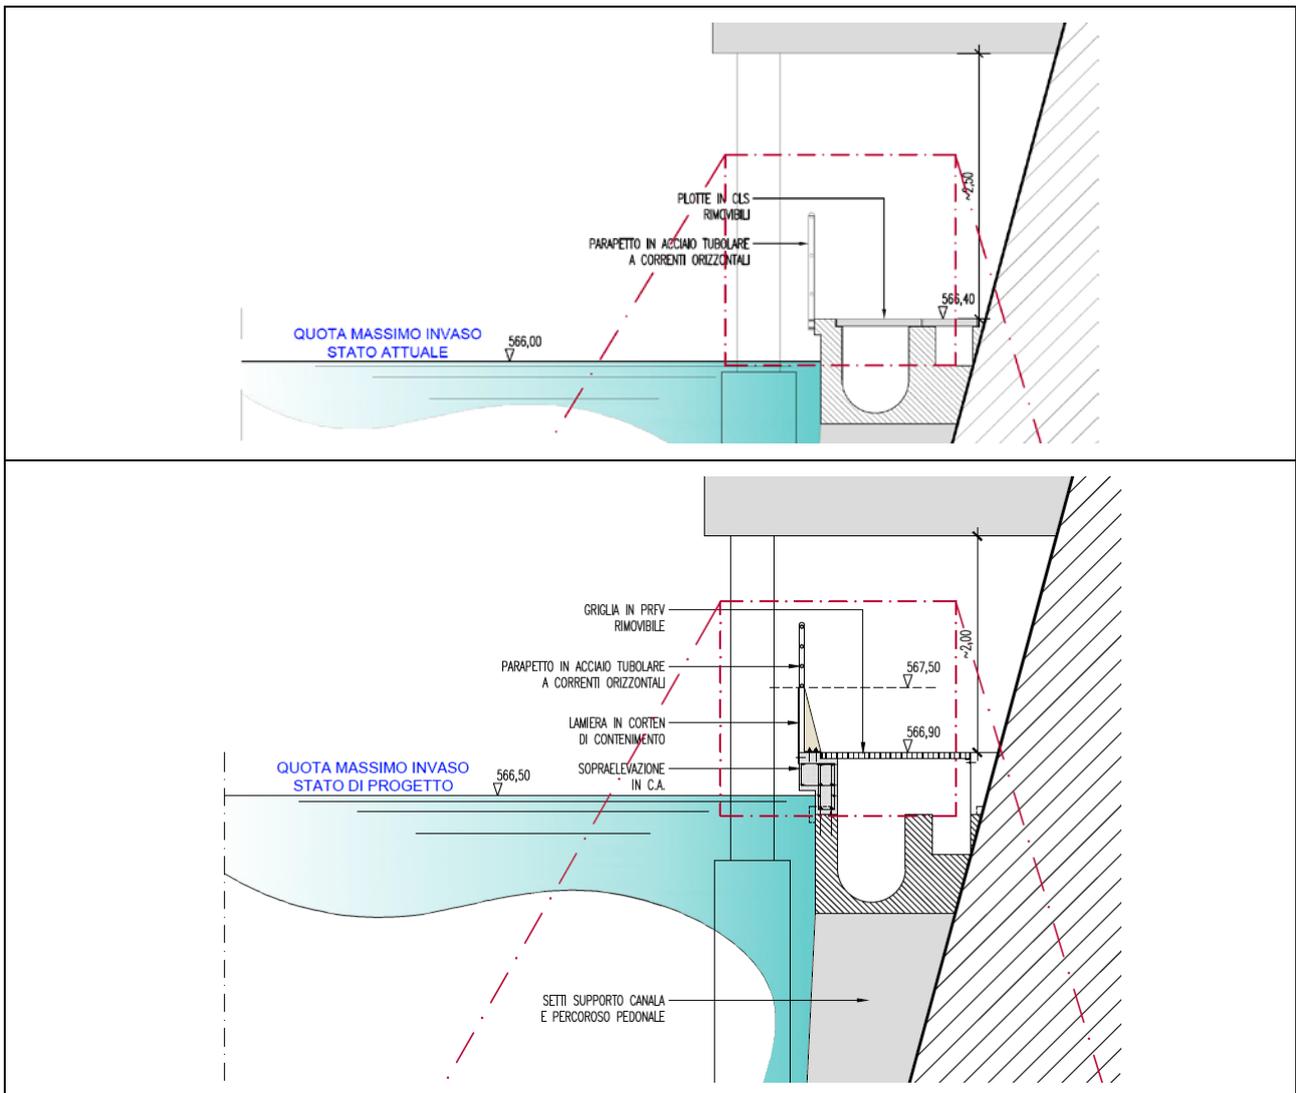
confronto tra stato attuale e proposta di progetto del camminamento sotto la casa di guardia
